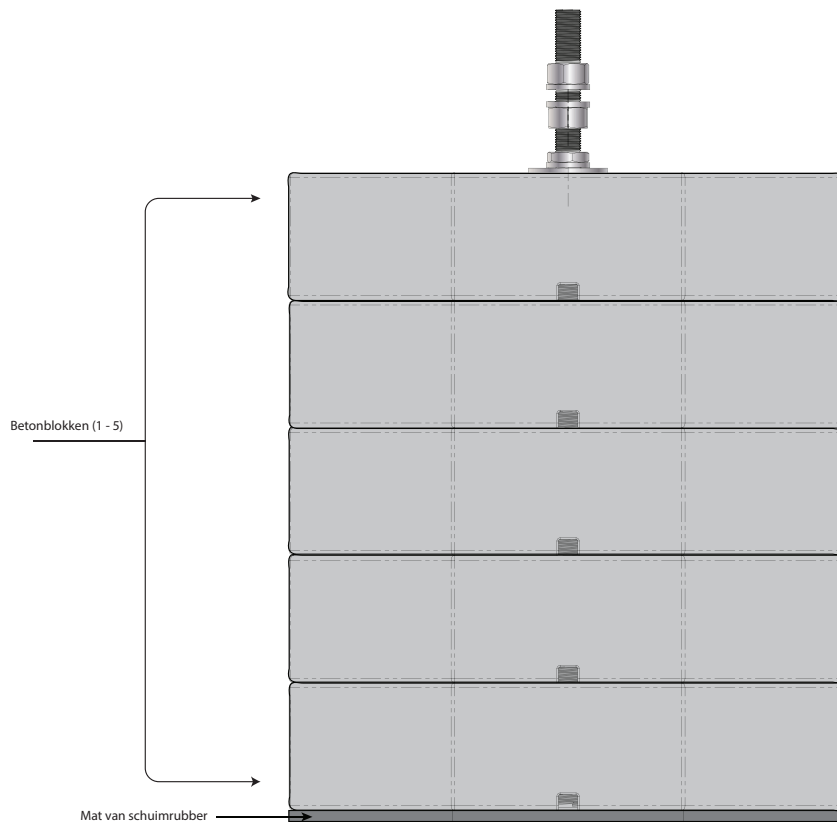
Gestapelde betonblokken voor een mast-standaard op een horizontale locatie
